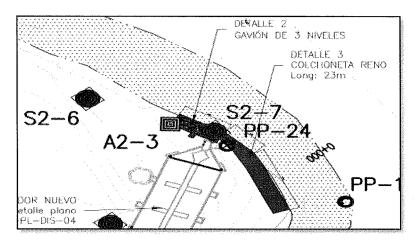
Plano HMC-122-PL-DIS-18.
